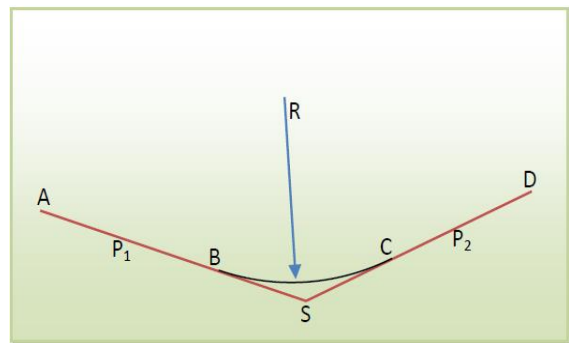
schématisation d'une trace en plan avec raccordement
